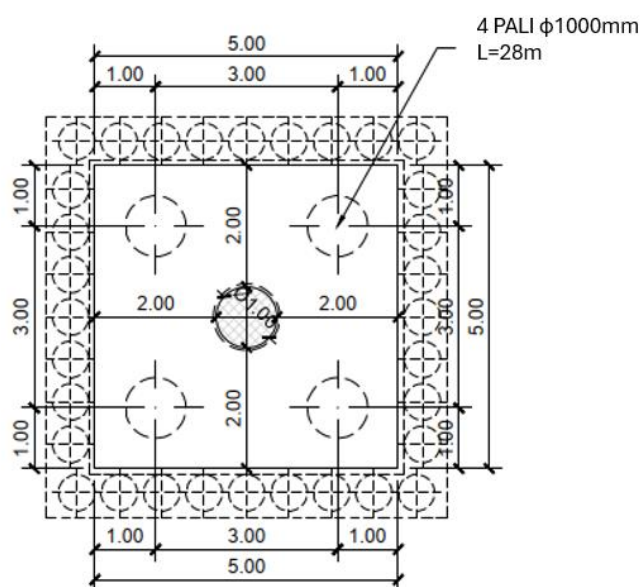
Carpenteria Tipo per fondazioni colonne da 3 a 5
